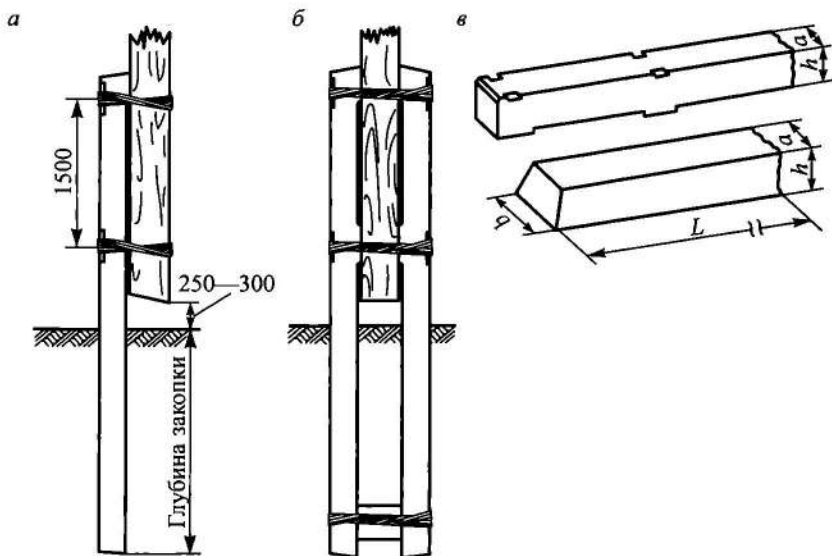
Схемы установки деревянных опор на железобетонных приставках (а, б); в — общий вид приставки трапециевидального сечения
